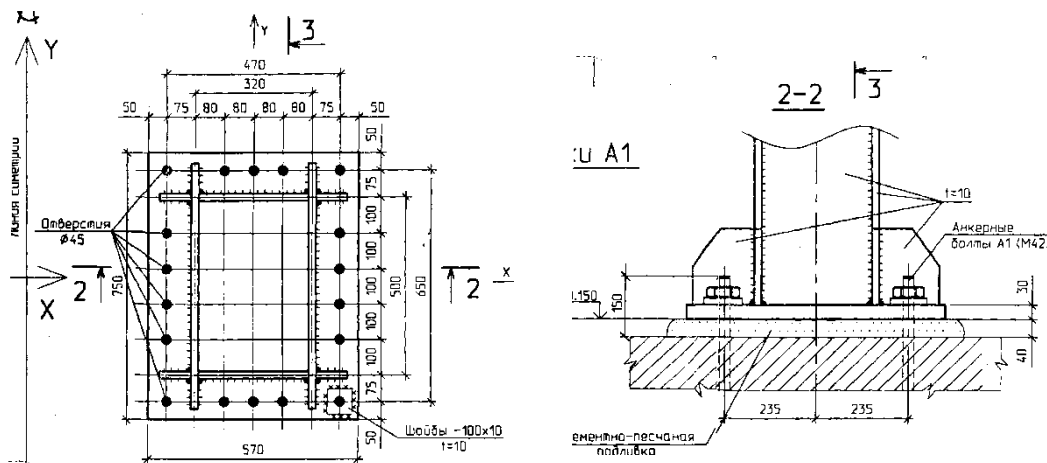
Установочна плита ФП 1 фундаменту типу 1
